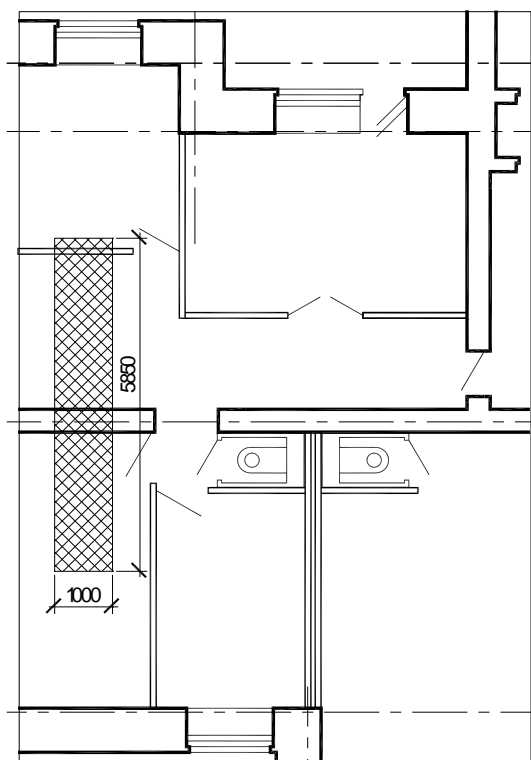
Грузовая площадь для внутренней стены 9-этажной секции
